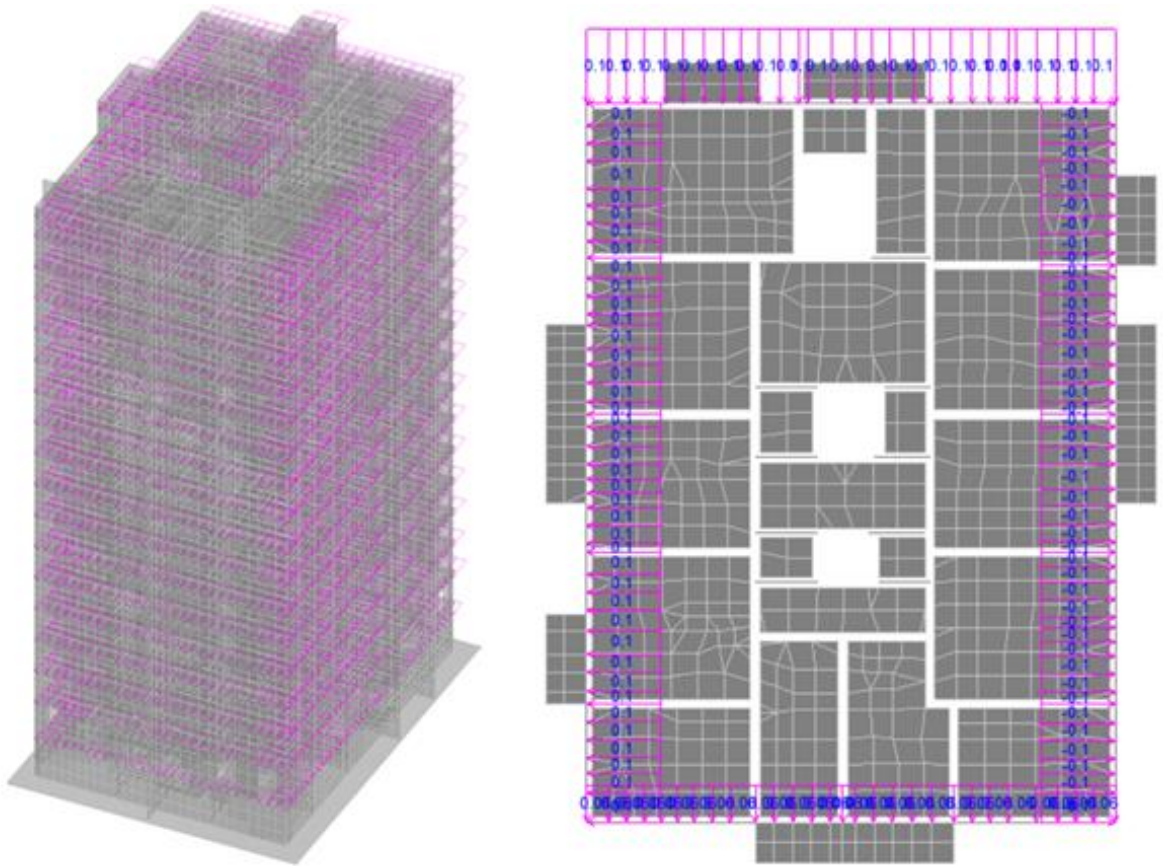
загрузка 12 – ветровая нагрузка 1 (слева – все здание, справа – перекрытие подвала)
